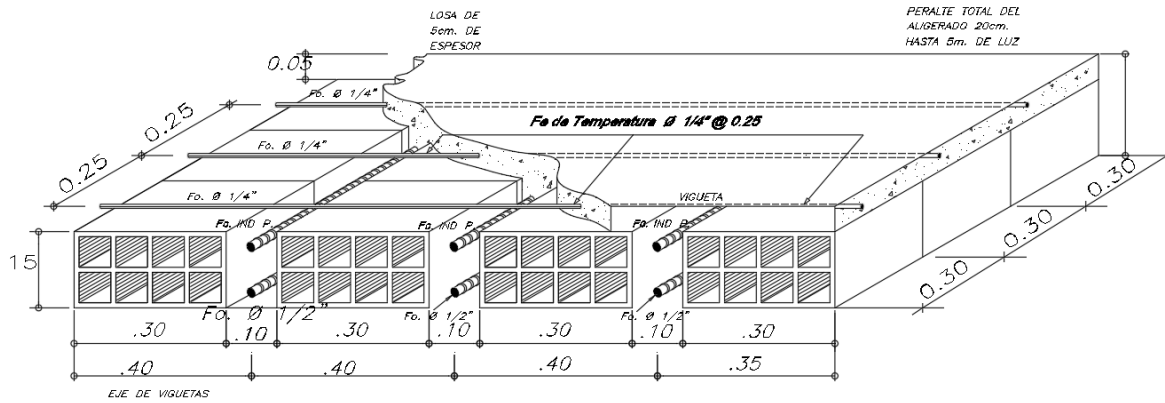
Detalle de losa aligerada E = 0.20 m
